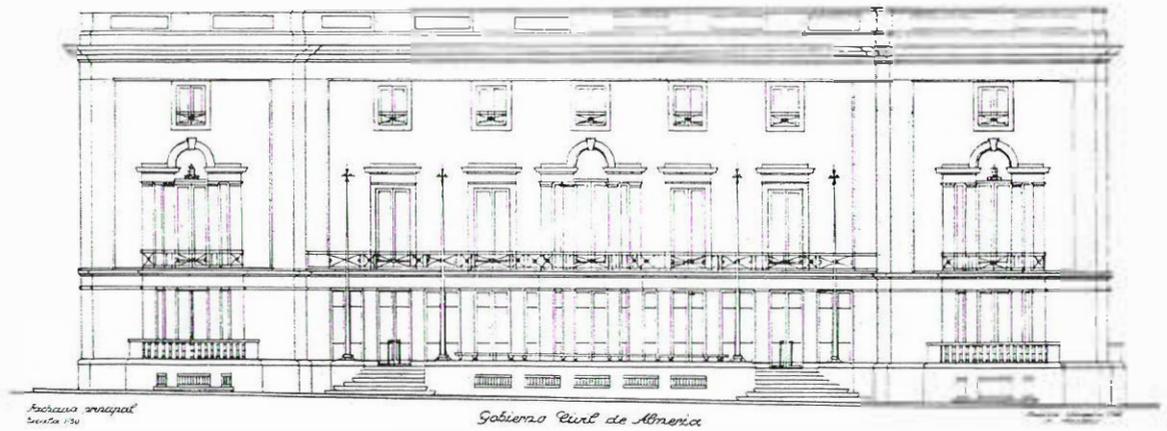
Gobierno Civil (1.940) en C/ Arapiles, de Carlos López Romero. Alzado fachada principal.
